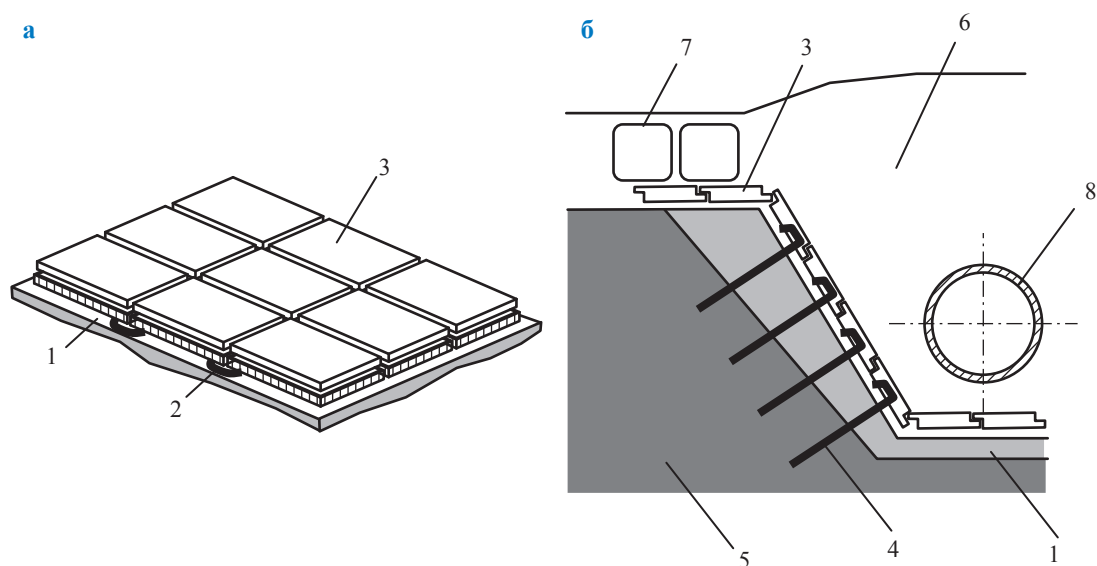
Схема теплоизоляционного экрана: общий вид (а); пример его укладки в траншее (б), где 1 – выравнивающий слой грунта; 2 – узел гибкой связи; 3 – теплоизоляционный модуль; 4 – анкер; 5 – мерзлый грунт; 6 – траншея; 7 – мешки с грунтом; 8 – трубопровод
